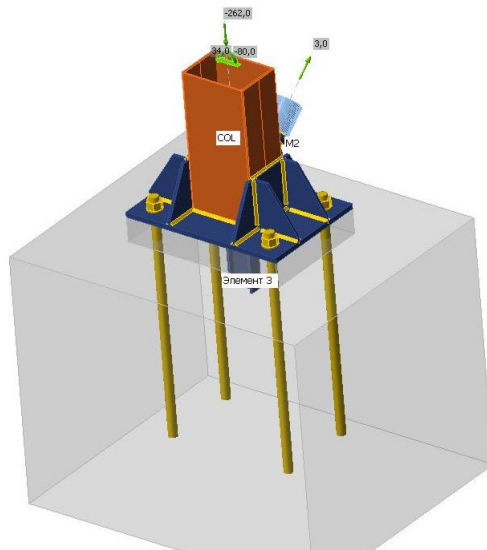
Модель з'єднання колони з бетонним фундаментом в програмі Idea StatiCa
